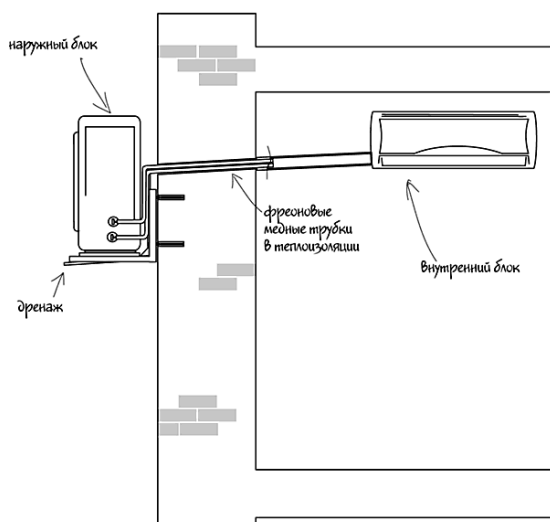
Схема прокладки соединительных патрубков и силового кабеля сквозь стену
